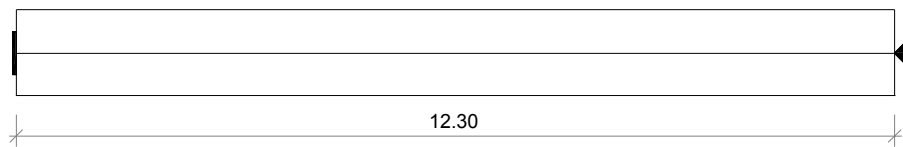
VIGA PRÉ-ESFORÇADA EM PLANTA (AUTOCAD)
